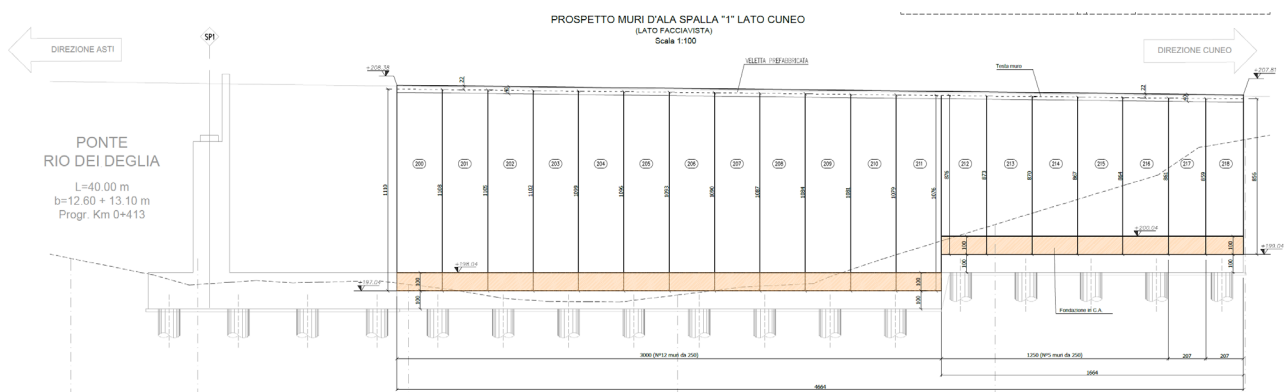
Prospetto strutturale dei muri prefabbricati sul Rio dei Deglia
